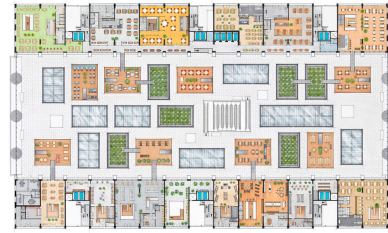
Market Hall, Rotterdam. Pianta del piano terra.
